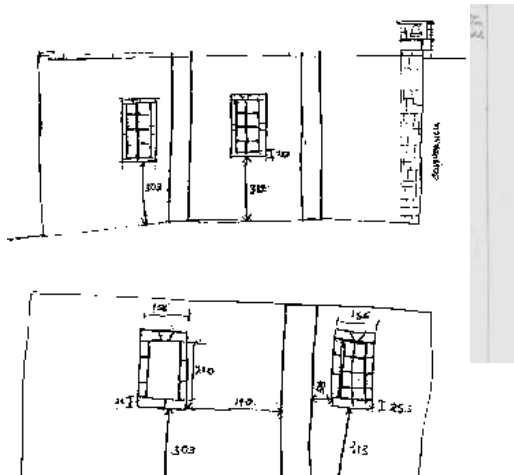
Croquis de planta y fachada oriente y poniente de la capilla y sacristía. Dibujo: Enrique Ruíz
